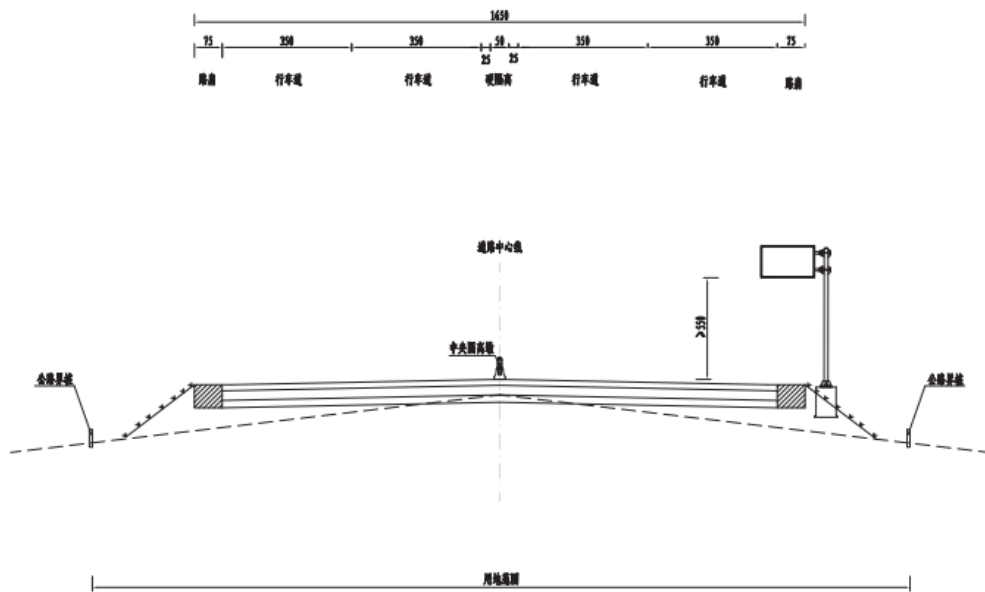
16.5m 路基横断面图 (K0+650-K0+660)
